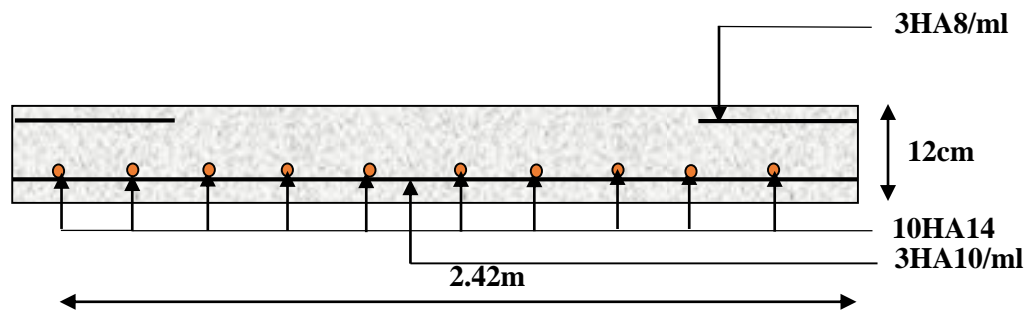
Schéma de ferrailage de la dalle pleine type N° 3.
